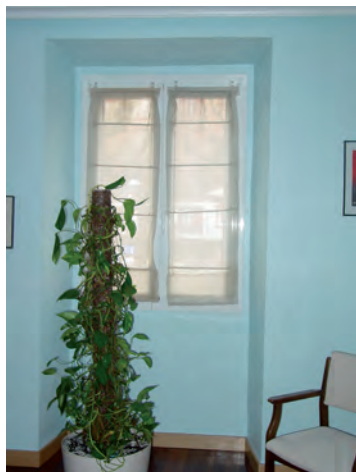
25. PUERTA DE BALCON DEL 2º A FACHADA TRASERA
